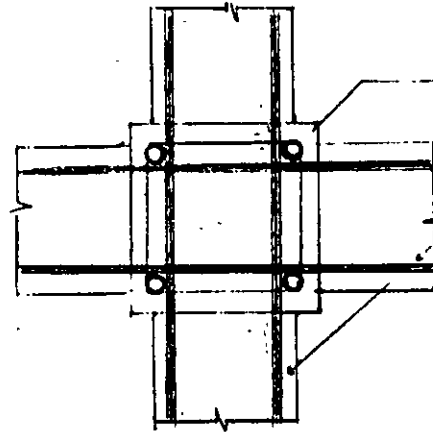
Anclaje del refuerzo longitudinal en vigas extremas de marcos dúctiles
